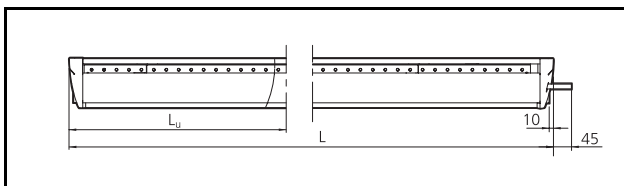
Adriatic, connessione canale 125 mm, vista dal lato corto.
